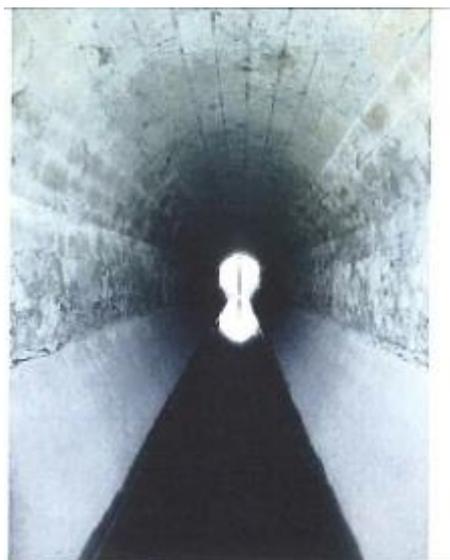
ru d'Oly ; Coupe de l'ouvrage de franchissement de la voie ferrée
